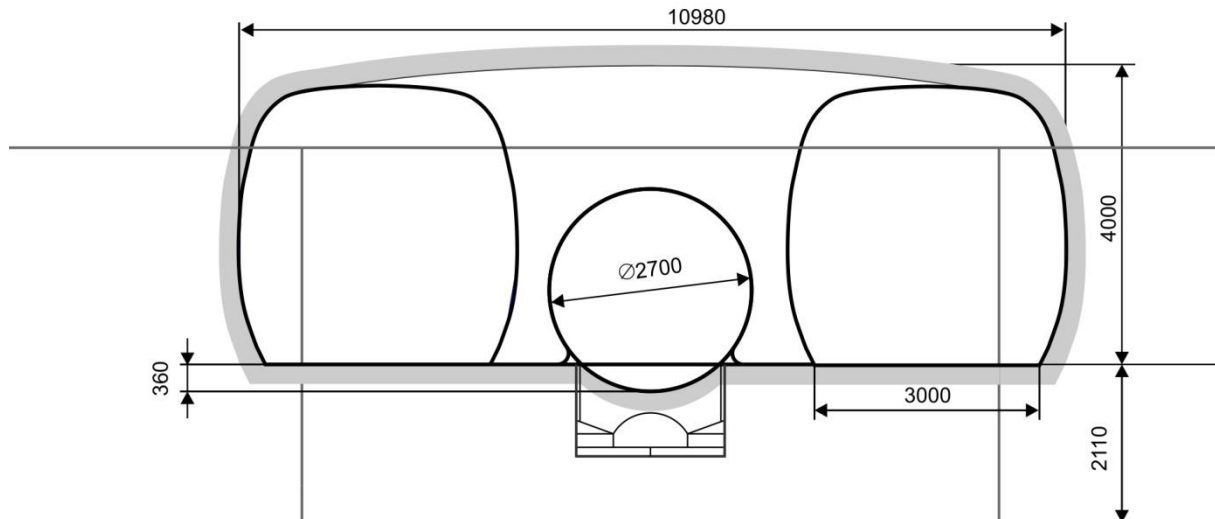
Skizze Rückholungsstrecke senkrecht zur Einlagerungsstrecke
